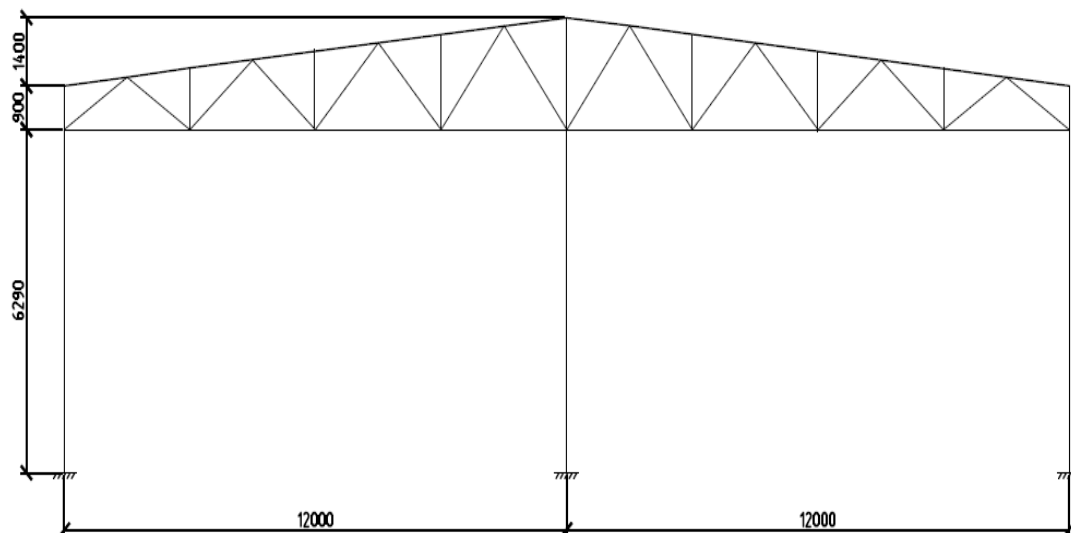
□ Расчетная схема поперечной рамы □
